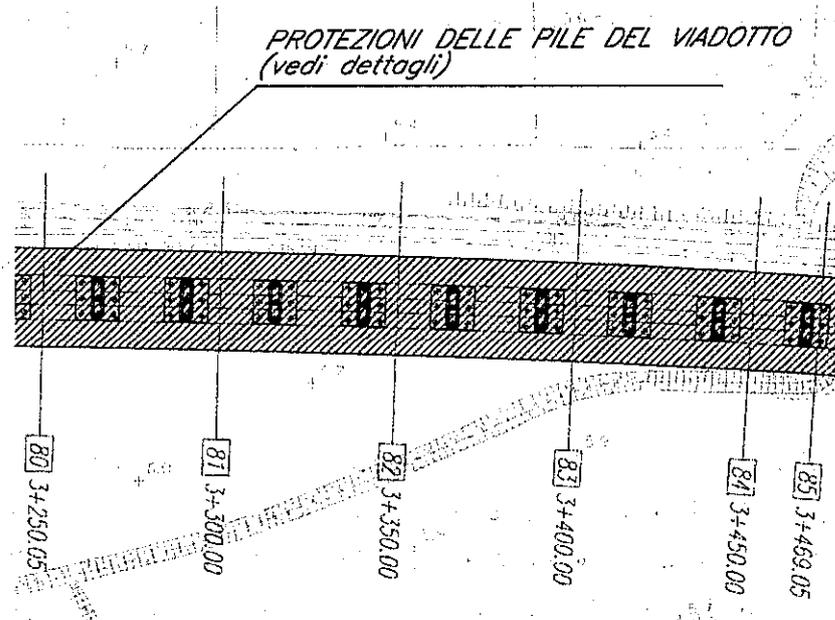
Protezioni al piede delle pile - stralcio planimetrico.
